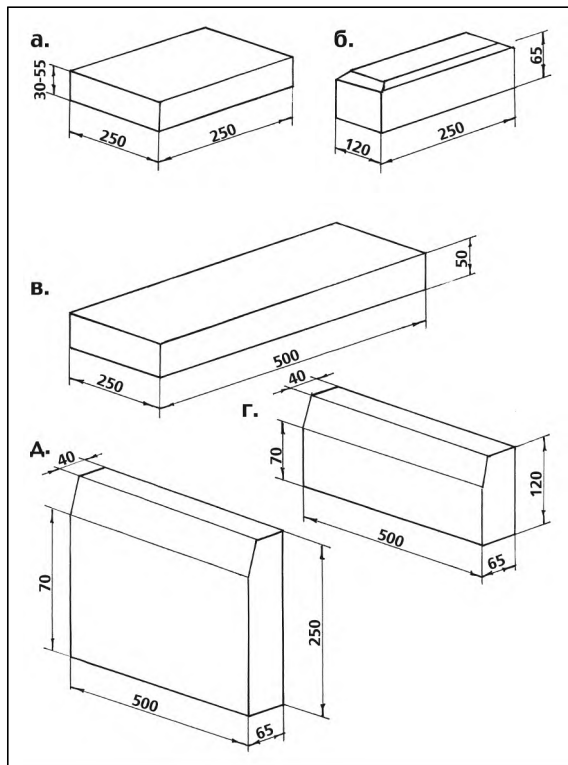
Некоторые бетонные изделия, применяемые при благоустройстве сада:
